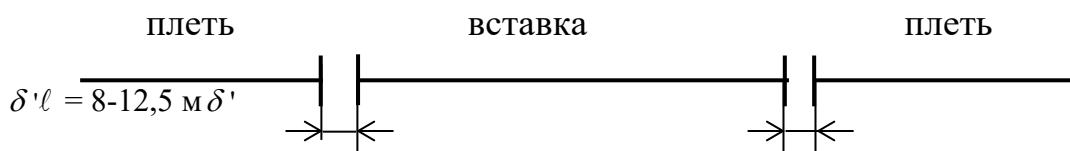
Схема вварки рельсовой вставки алюминотермитной сваркой
